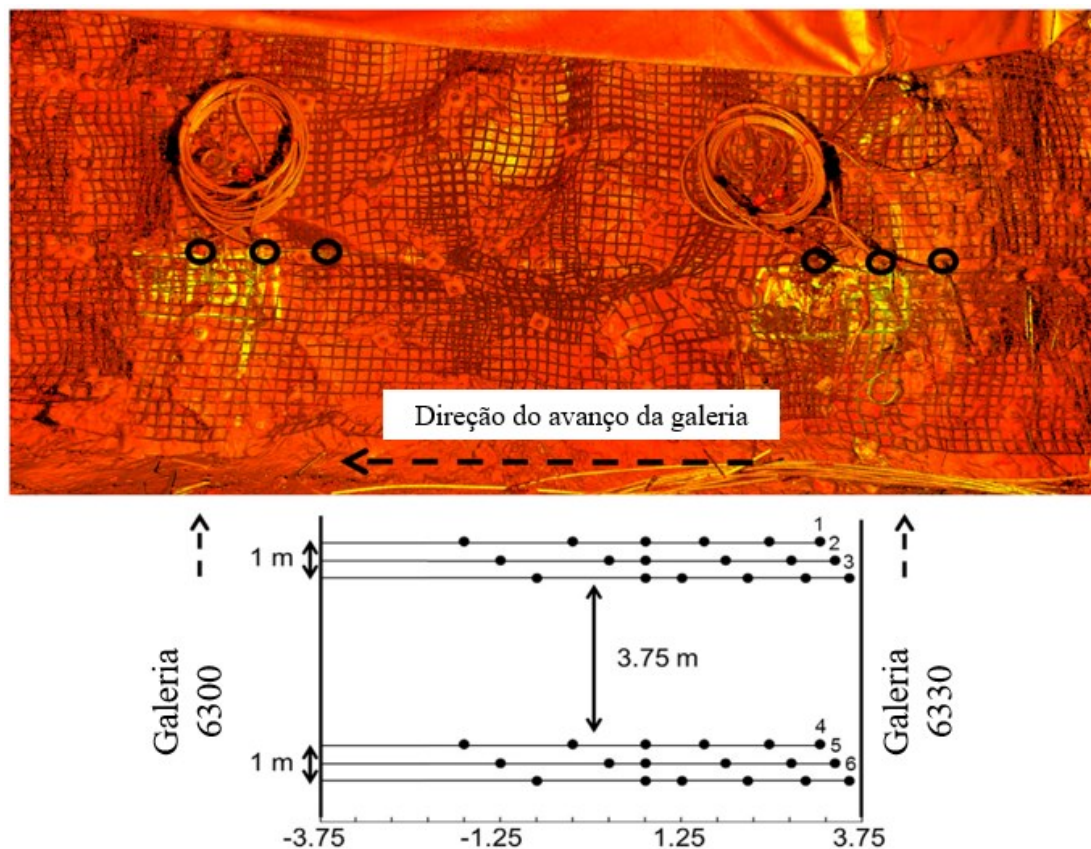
Localização dos extensômetros instalados no pilar entre as galerias 6300 e 6330 (modificado - Walton et al., 2016).
